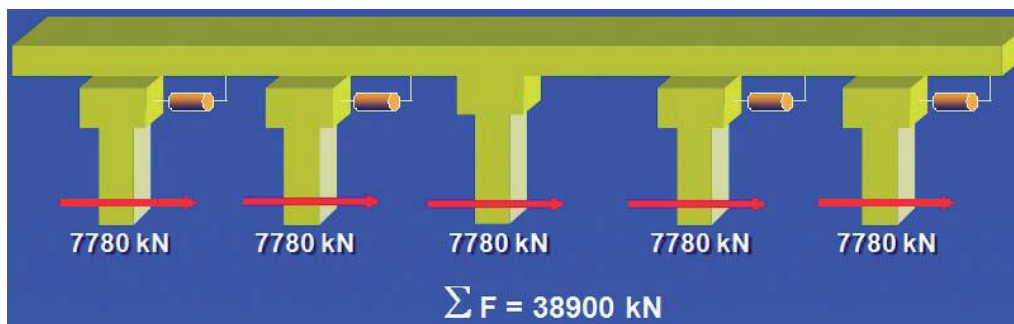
Puente con STU sometido a un esfuerzo longitudinal [11]
